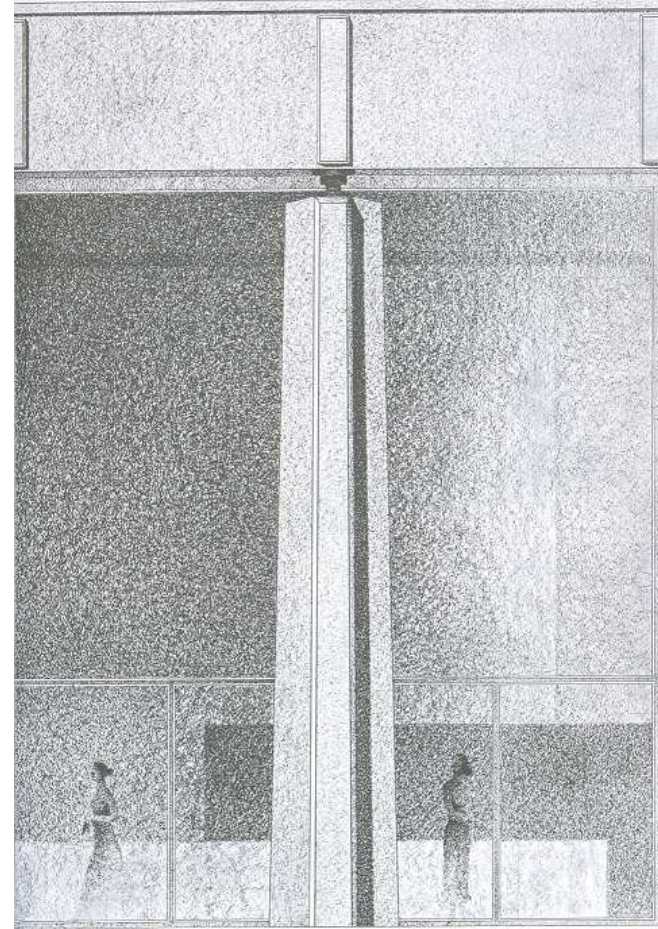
Desenho do apoio, articulação e cobertura em grelha
